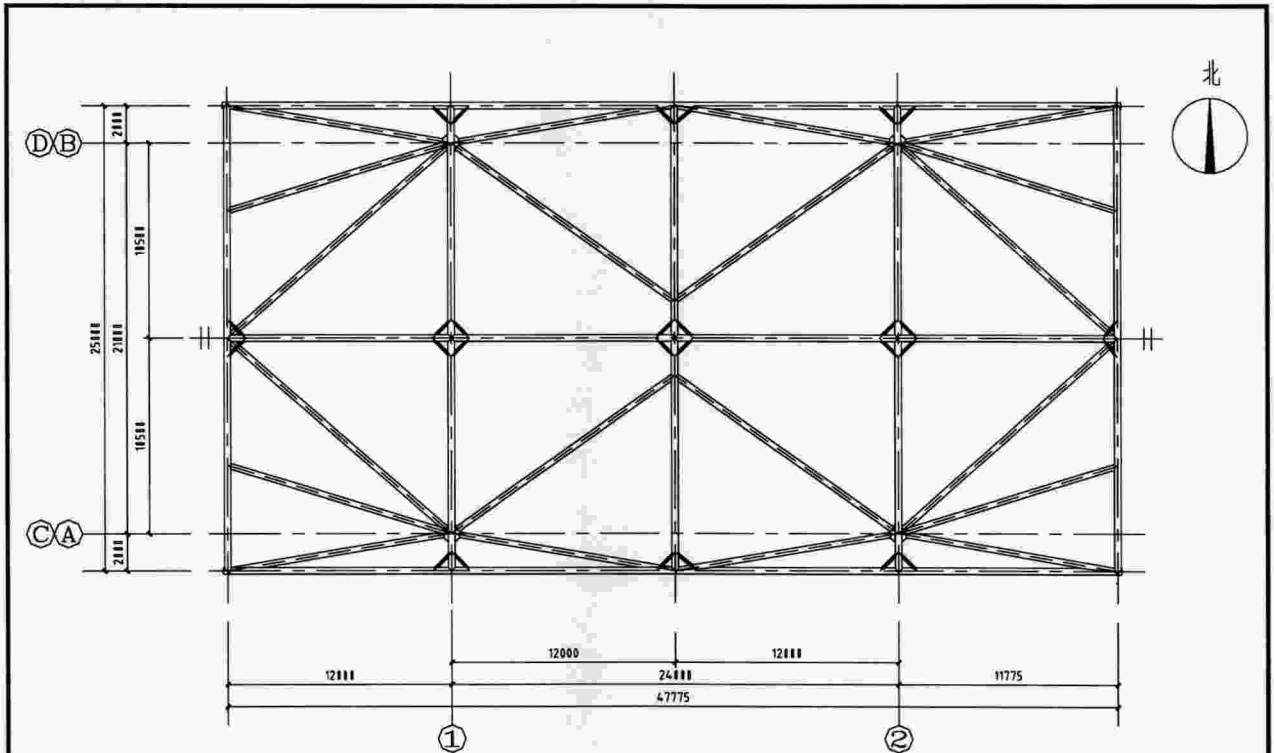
标准单体 A 结构平面布置示意图(单位: mm)
